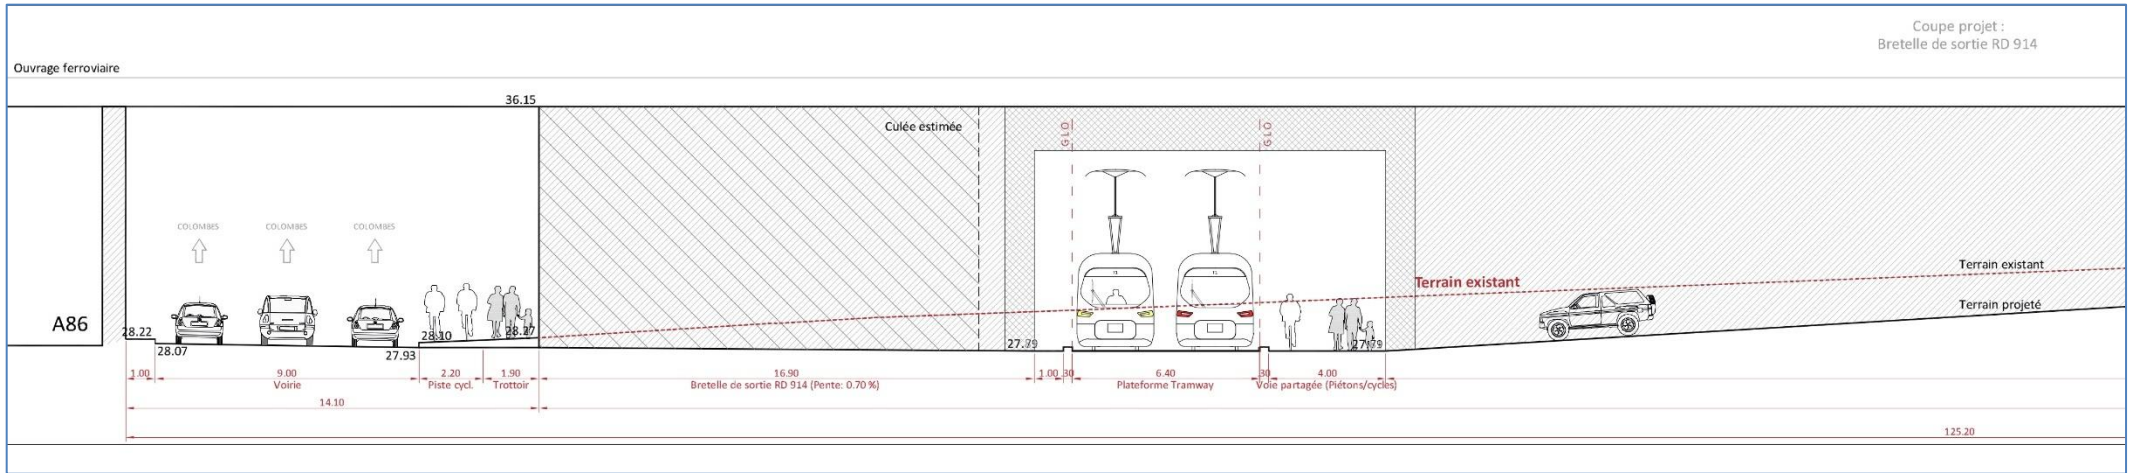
Séquence 1 – section D – Franchissement avec croisement – bretelle de sortie
